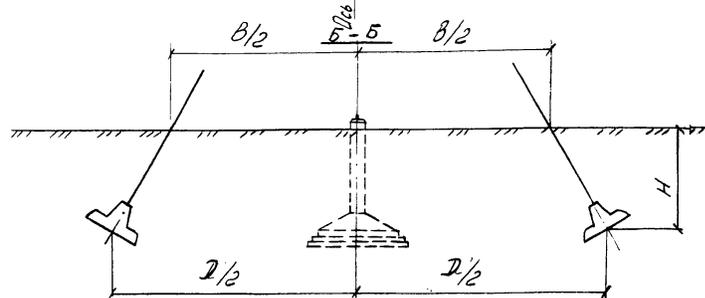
Схема фундаментов под промежуточно-узловую опору ПУБ-5.
